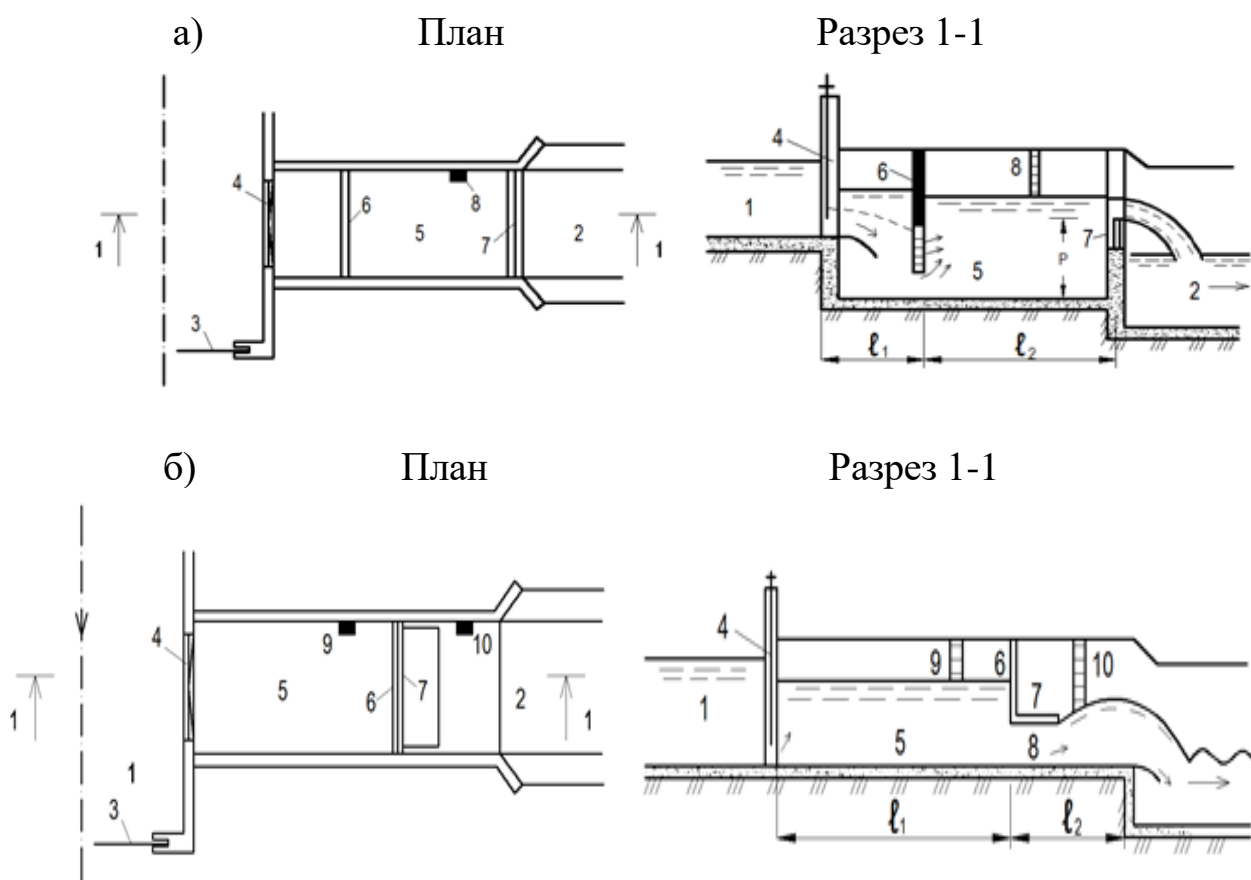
Размещение водомеров типов «Водослив с тонкой стенкой» (а) и «Прямоугольный насадок» (б).
